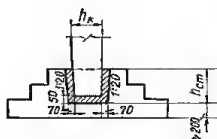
Фундамент со стаканом для заделки сборной железобетонной колонны.
